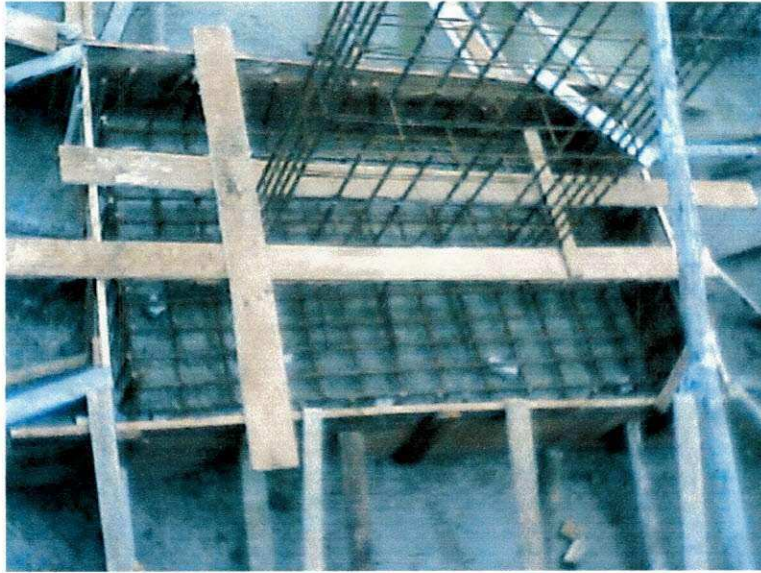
ESCORAMENTO DA FÔRMA E DA ARMADURA
